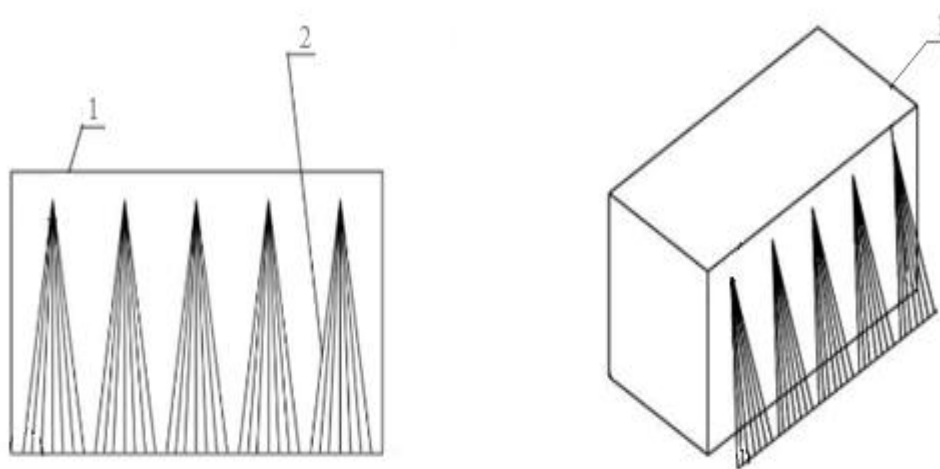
Варіанти розміщення тросів на фасаді будівлі
